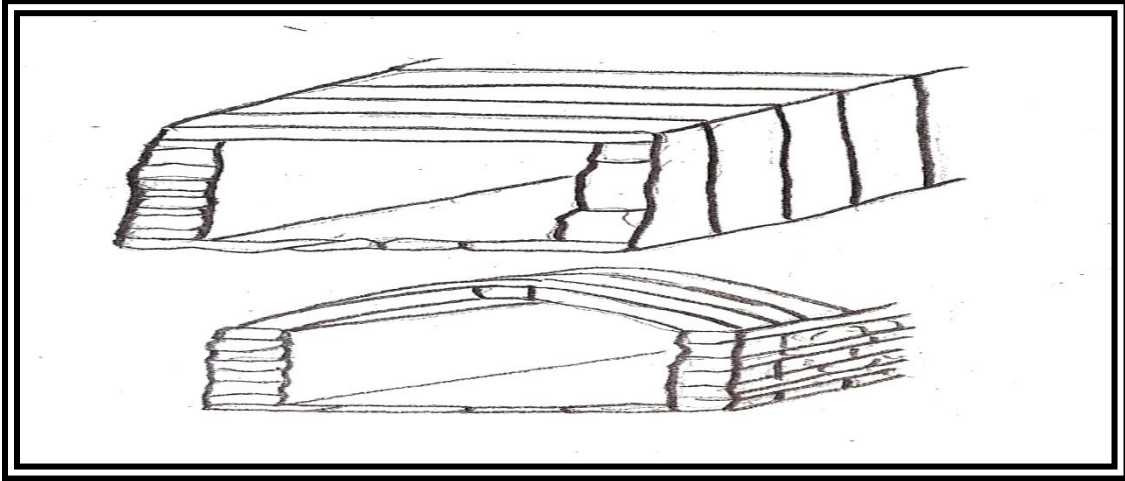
مسقط أفقي لإحدى خرزات عين الوزيرية
